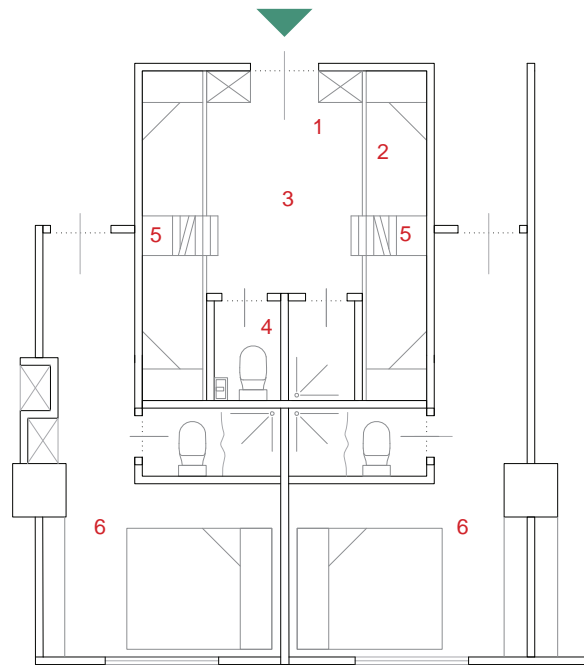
Zimmergrundriss - Amici Six Star Hotel
